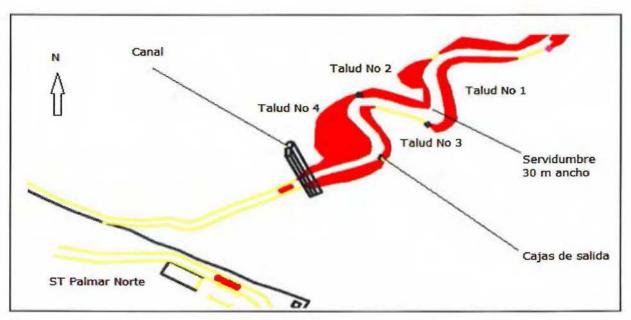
Vista en planta de los taludes en la ST Palmar Norte Fuente: ICE, 2011
